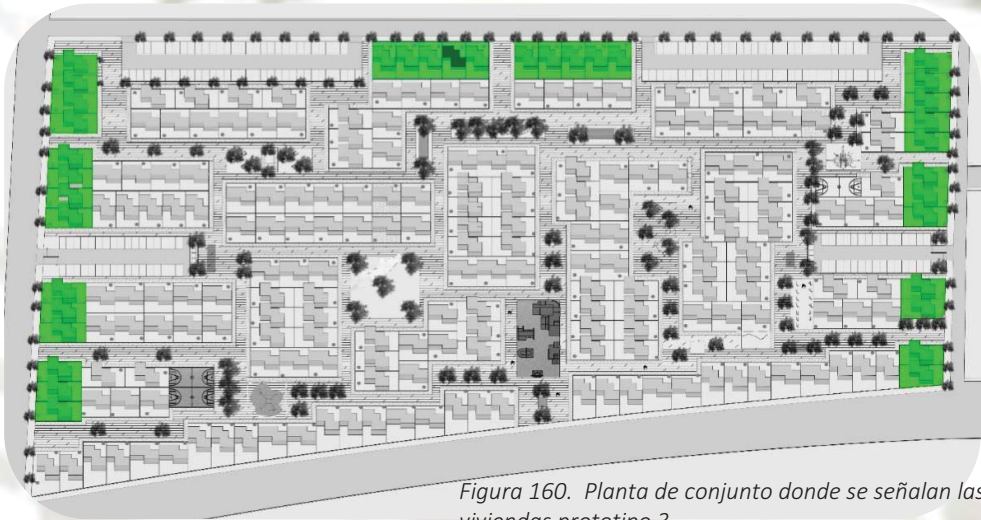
Planta de conjunto donde se señalan las viviendas prototipo 3.
